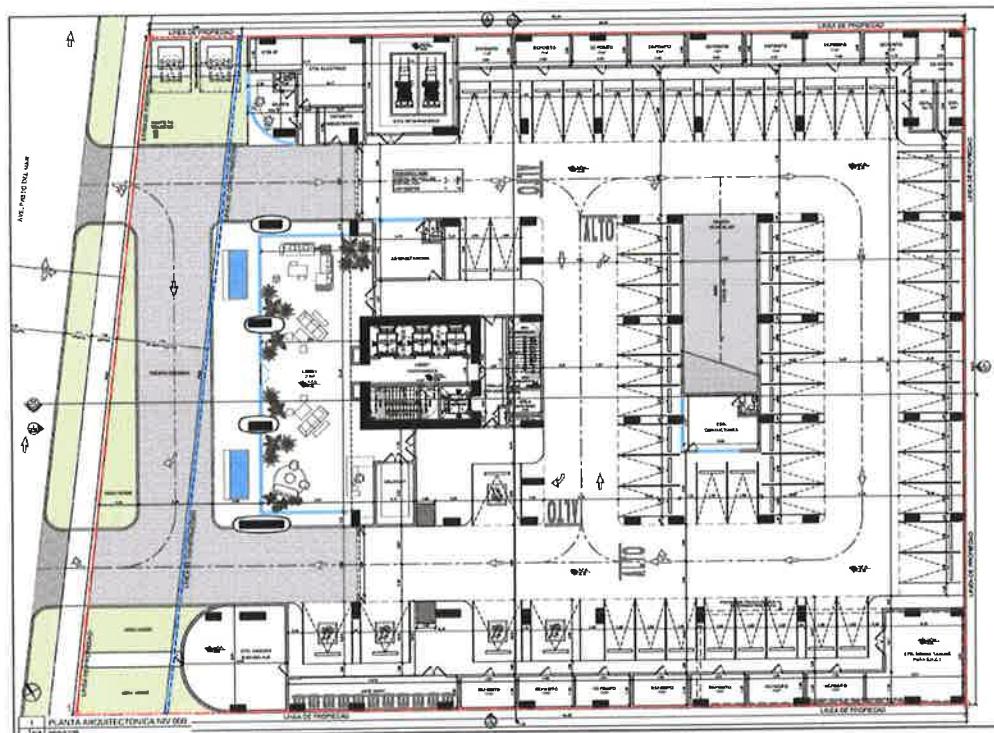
Planta arquitectónica nivel 000. Fuente: Via Chicago Architects X Diseñadores
